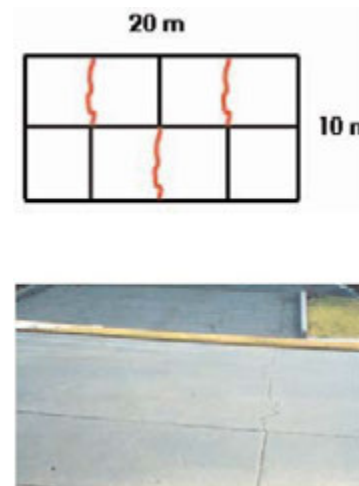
Aparición de fisuras por disponer juntas al tresbolillo.
